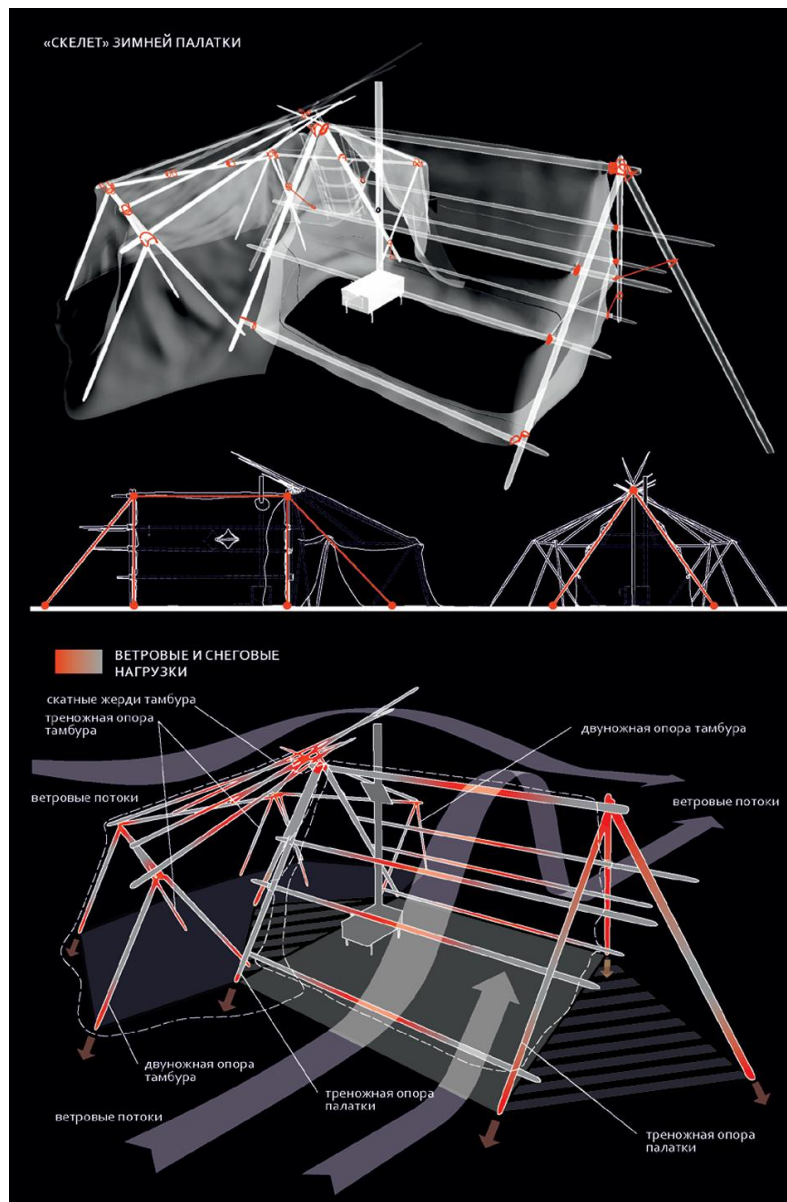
Ветровые и снеговые нагрузки на жилище [1, с.119]
